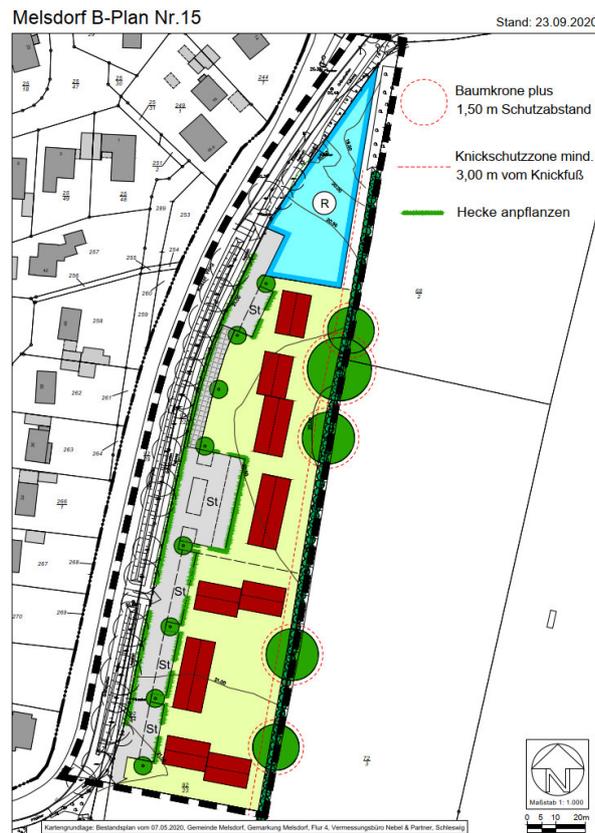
Bebauungsvorschlag B-Plan 15 (Planungsbüro GR Zwo; Stand 23.09.2020)
